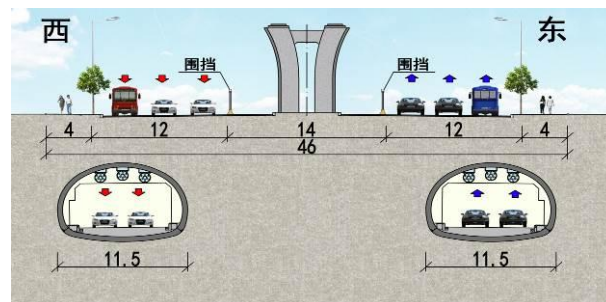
重庆路双向八车道段主线桥梁下部结构施工调流断面图
